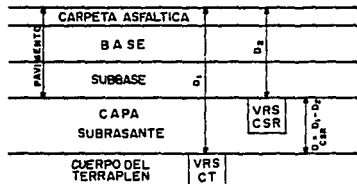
A—Figura que muestra en forma objetiva los espesores D_1 y D_2 para la estructuración de una vía terrestre con pavimento flexible. Método de Porter Modificado (Padrón).
